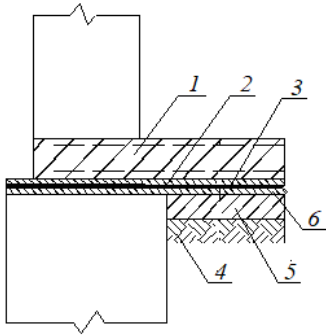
Сочетание сплошного барьера с мембраной: 1 — монолитный железобетон; 2 — защитный слой; 3 — рулонный гидроизоляционный материал; 4 — выравнивающая стяжка; 5 — подготовка из тощего бетона; 6 — уплотнённый грунт
